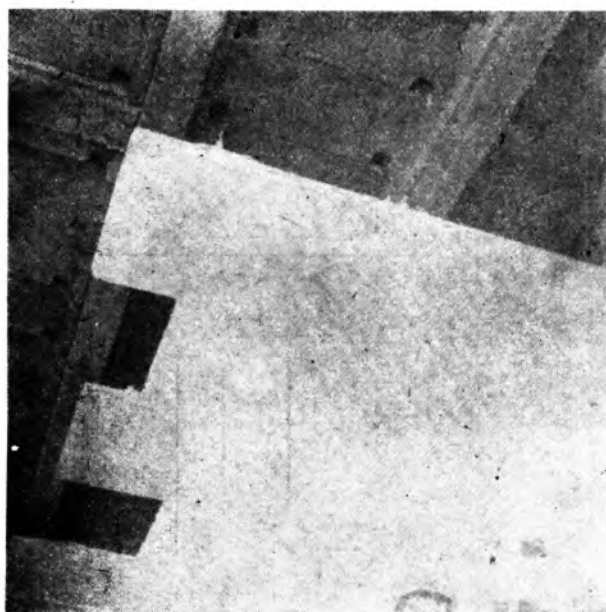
Podwieszanie płyt (dyl) gipsowych, stanowiących sufit stropu z elementów gotowych. Na pierwszym planie, u góry zdjęcia, widoczne są otwory w pustakach stropowych, w które zakłada się sprężynujące wieszaki z drutu do podwieszania płyt sufitowych.
